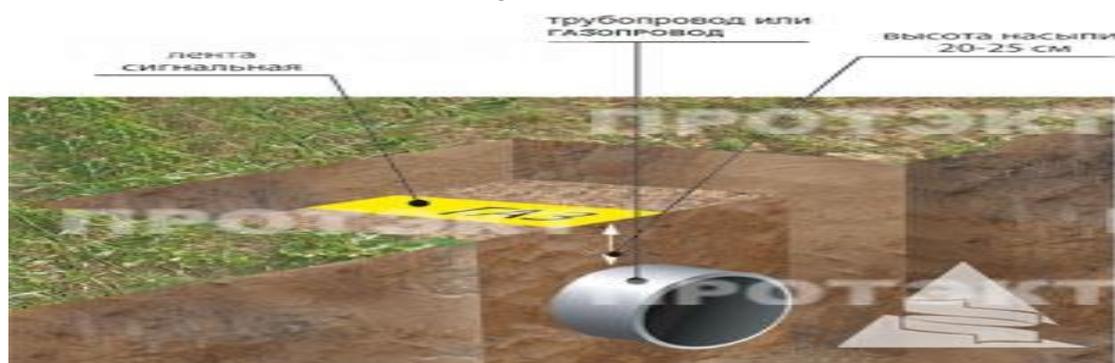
Схема укладки сигнальной ленты на газопроводе
